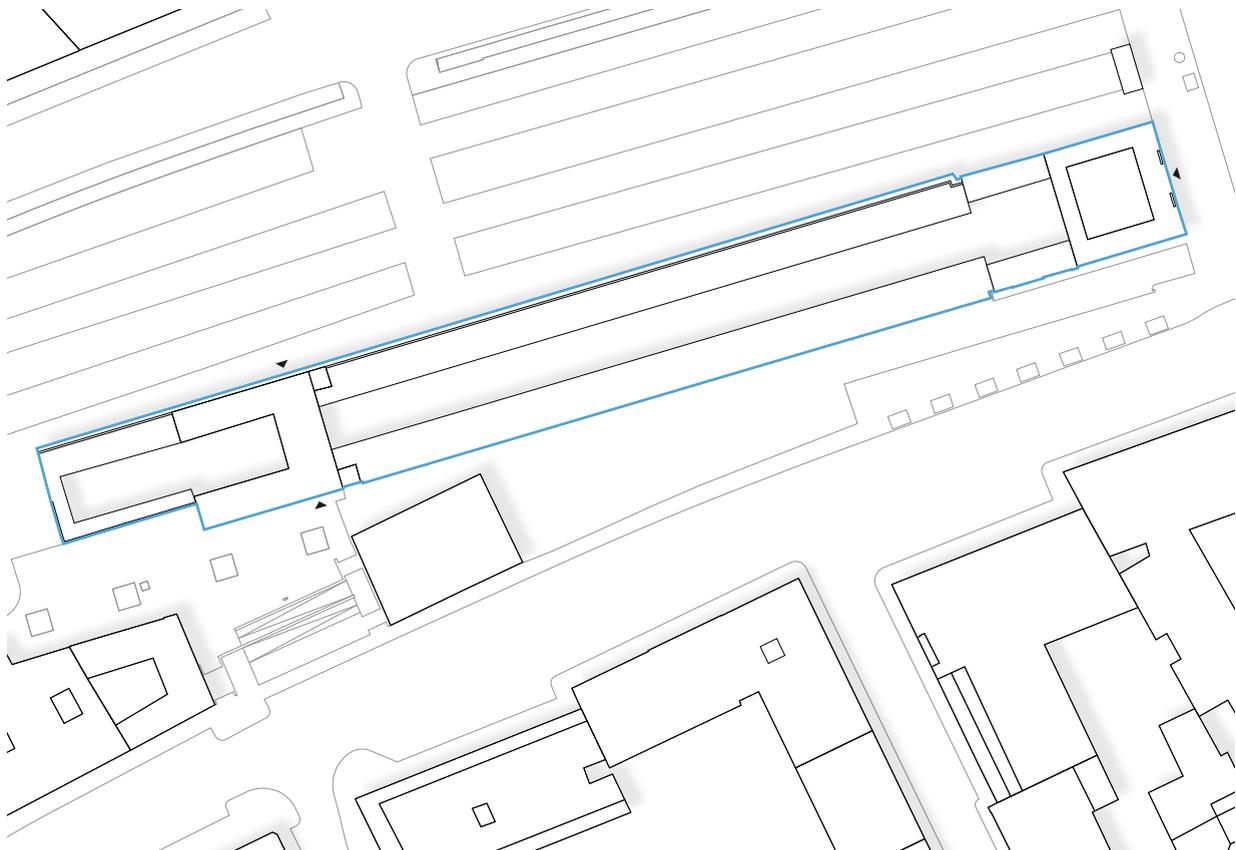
; Grundriss U-Bahnstation, Wiener Linien, UG 1:500
